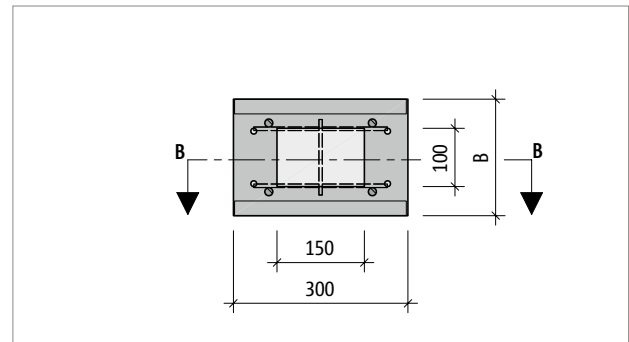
Schöck Sconnex® Typ W-N1T1: Produktgrundriss; Drucklagerfläche 150 × 100 mm
